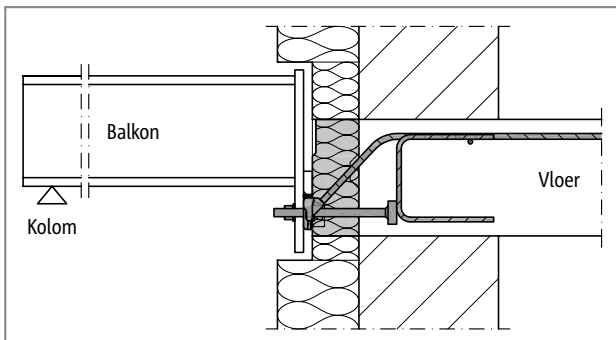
Schöck Isokorb® T type SQ: Ondersteund balkon
